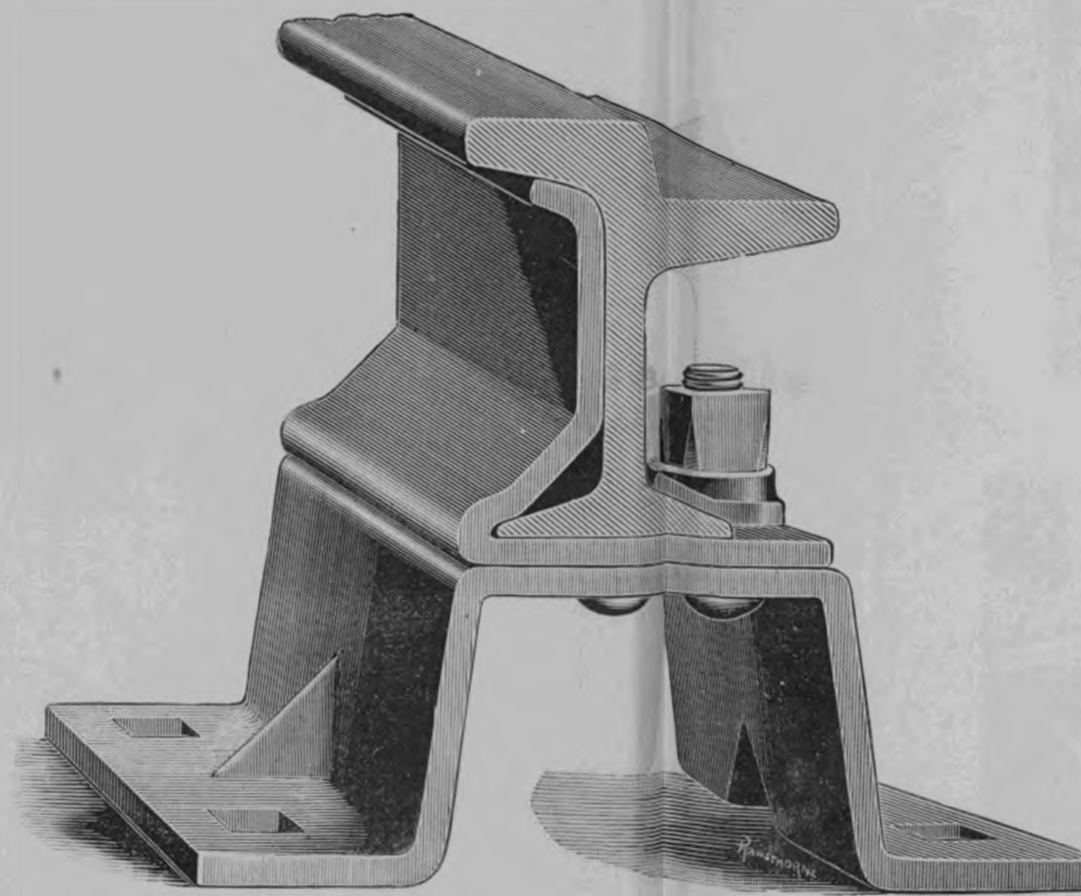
RAIL DE TRAMWAY POUR POSE DE VOIE DANS UNE CHAUSSEE PAVÉE (AVEC SUPPORT EN TOLE EMBOUTIE)
